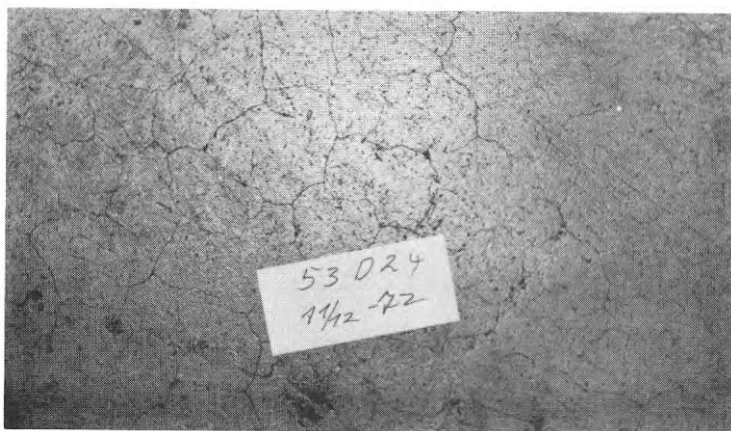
Obehandlat betonggolv i lasthall, 3 år.
